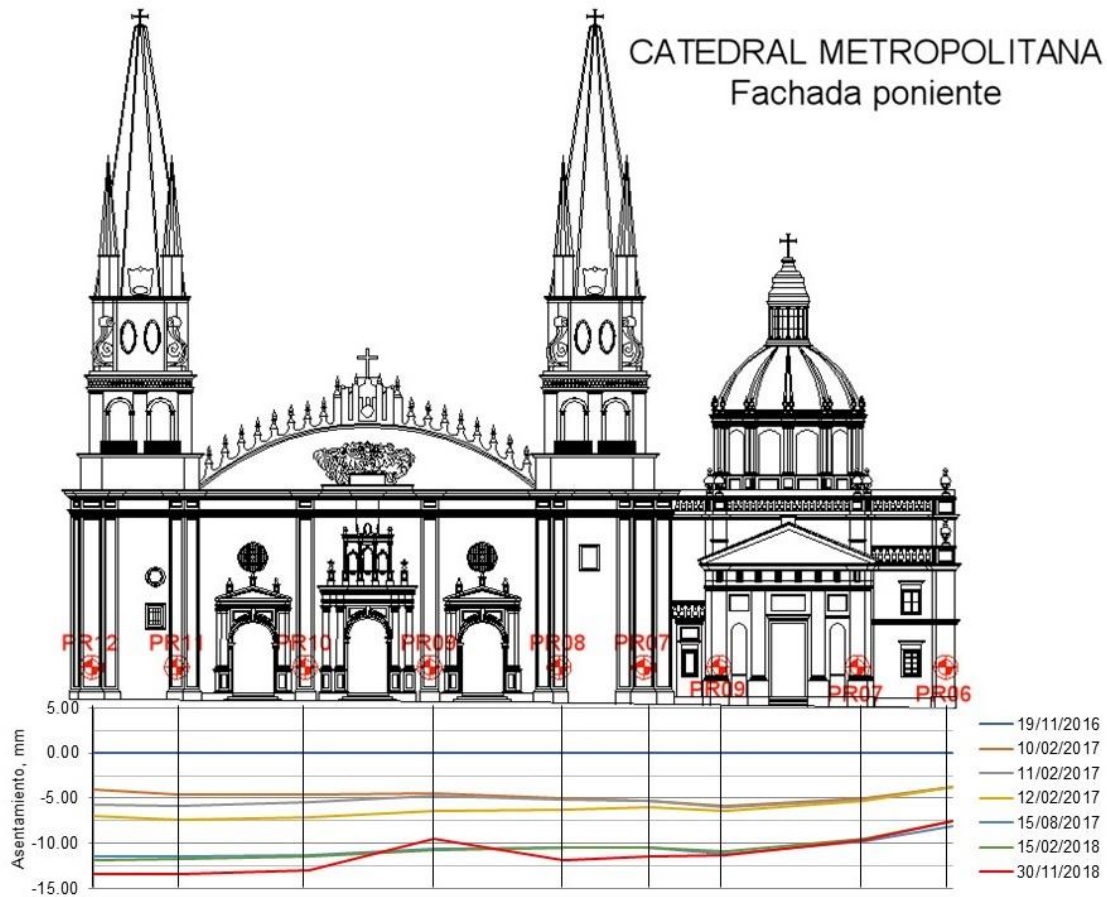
Perfil de asentamientos en la fachada poniente. Catedral y Sagrario Metropolitano.
